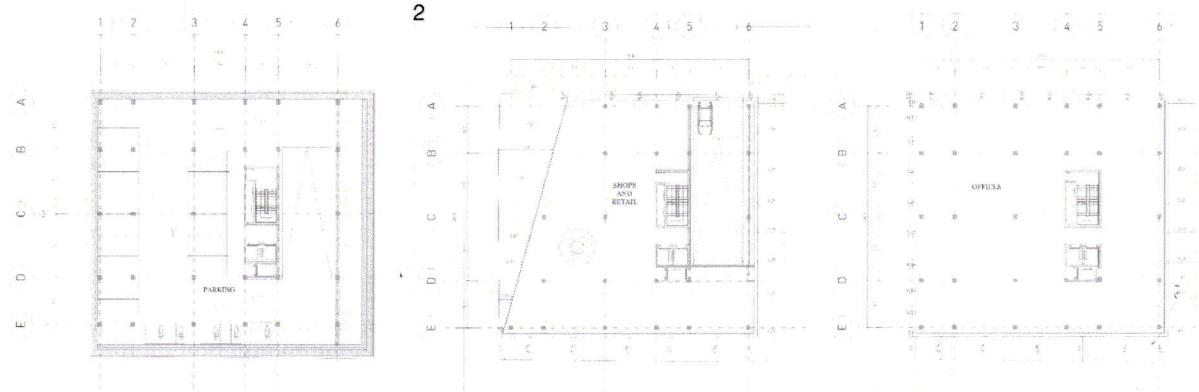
planet tip te: parkimeve, kati i biznesit dhe kai i zyrave
